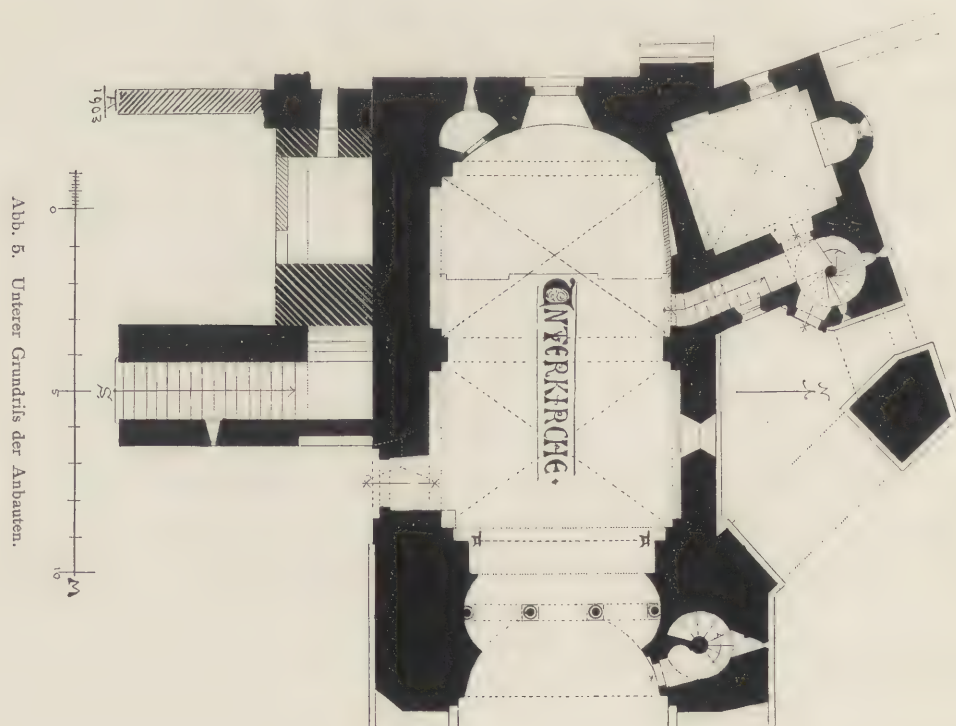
Unterer Grundriss der Anbauten.
